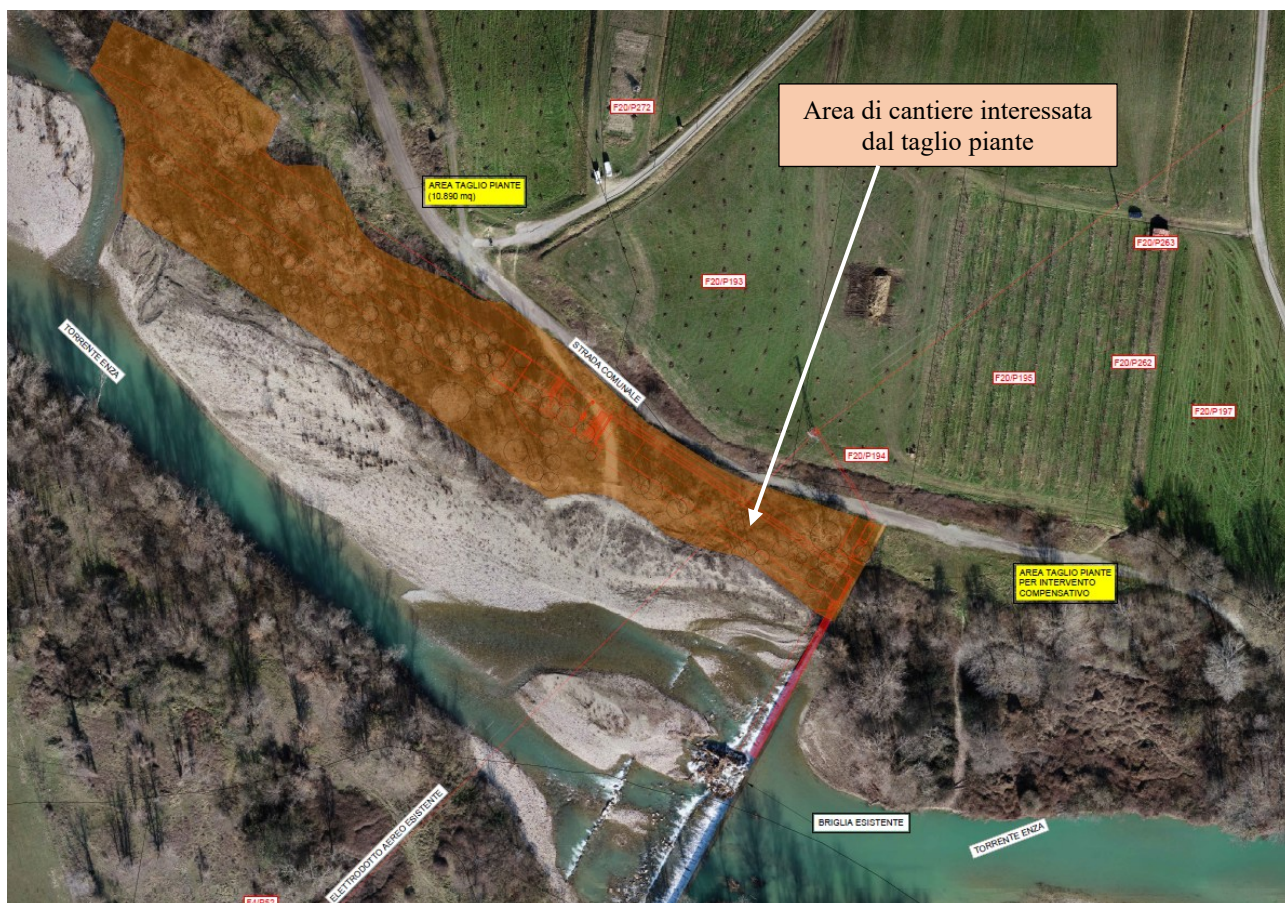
Planimetria con individuazione dell'area interessata dal taglio piante (elaborato ELG110)
